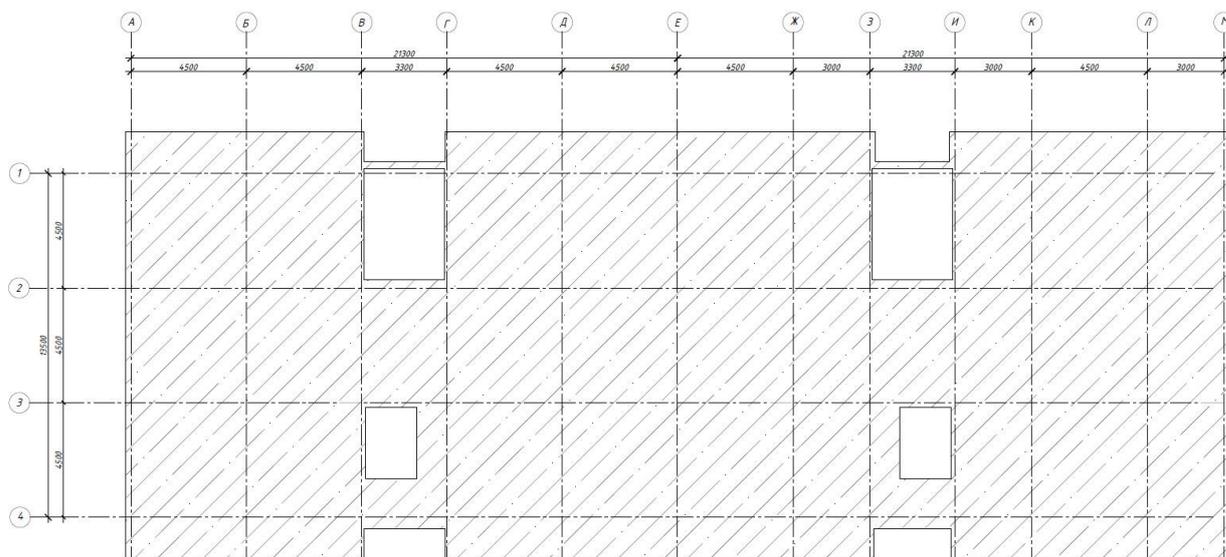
Компоновочная схема монолитного перекрытия
